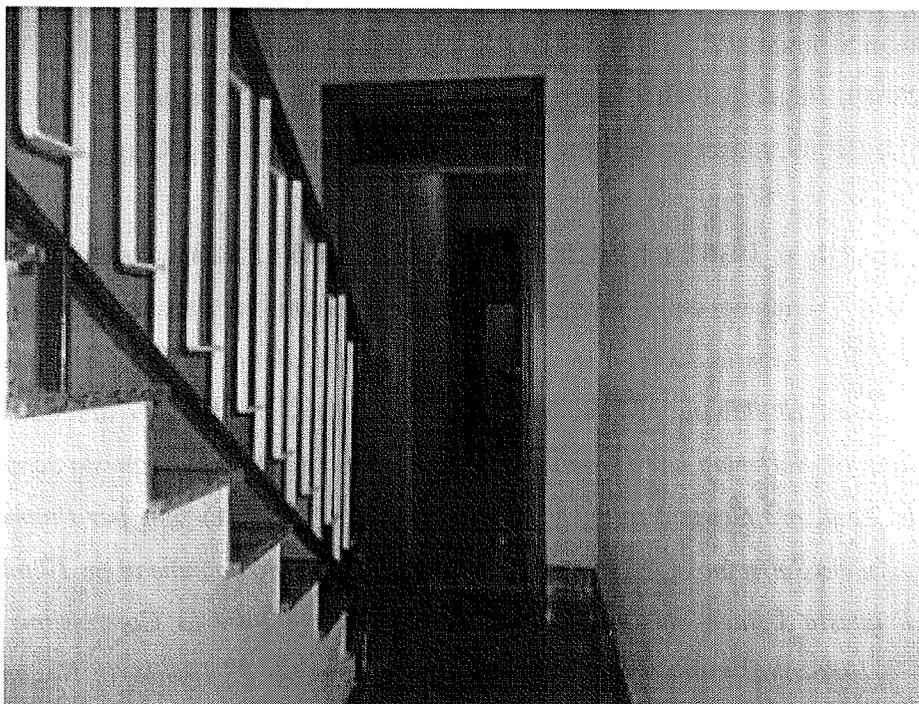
Immobile “1A” – Vista del corridoio dall’ingresso comune
